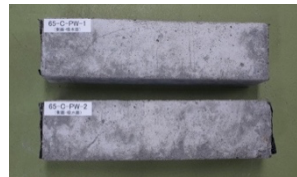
純水・ひび割れ有 写真-3 NaCl・ひび割れ有
